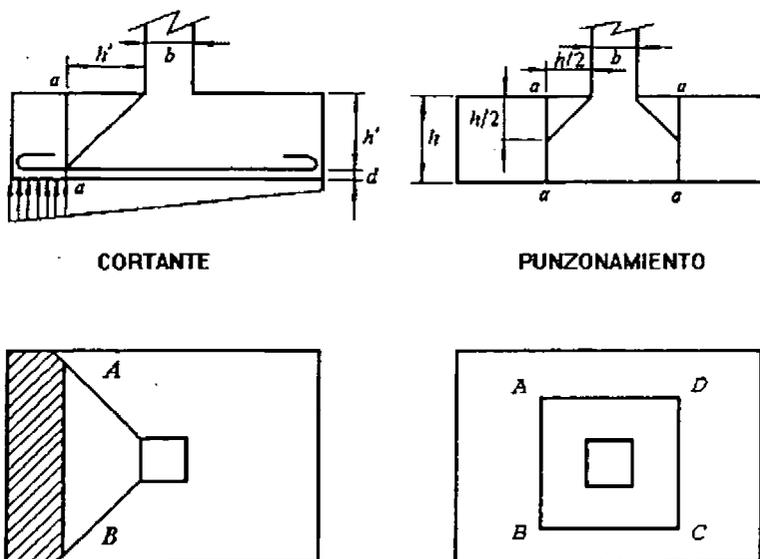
Secciones para el cálculo del cortante y del punzonamiento.
